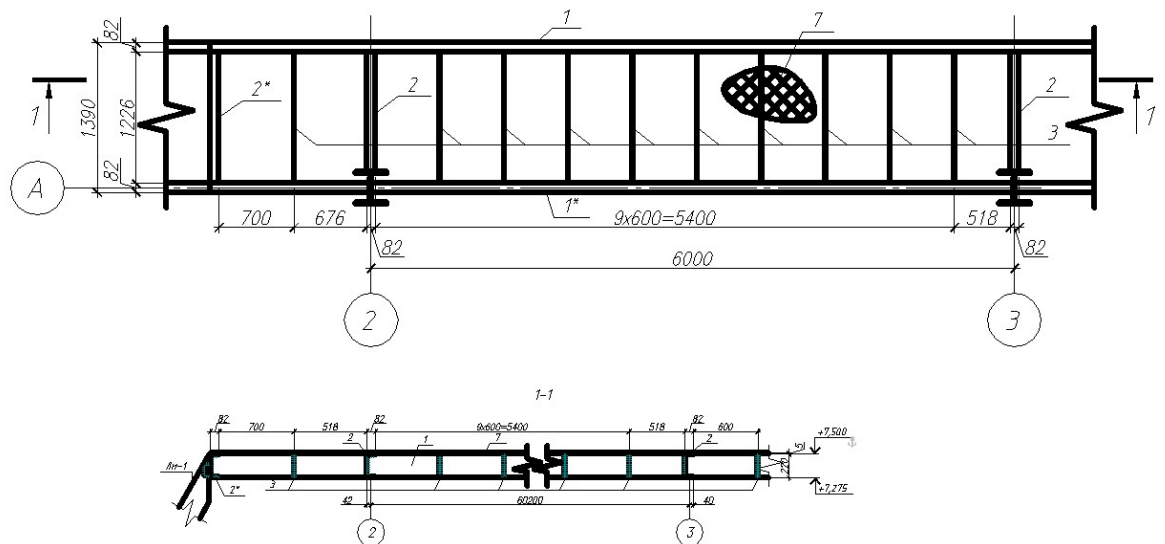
Схема расположения элементов площадки для обслуживания кранов
